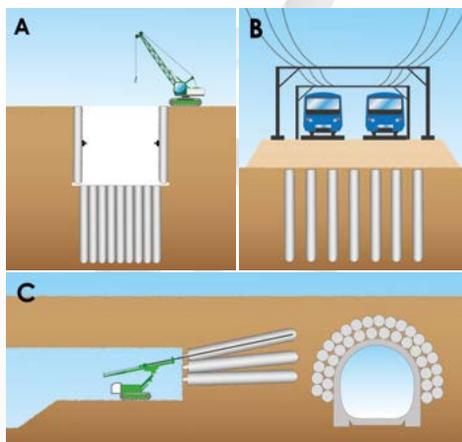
Algumas aplicações típicas de jet-grouting. a) suporte de escavação e plug de vedação, b) fundação de aterros, c) pré-suporte de túneis (Croce et al, 2014)
